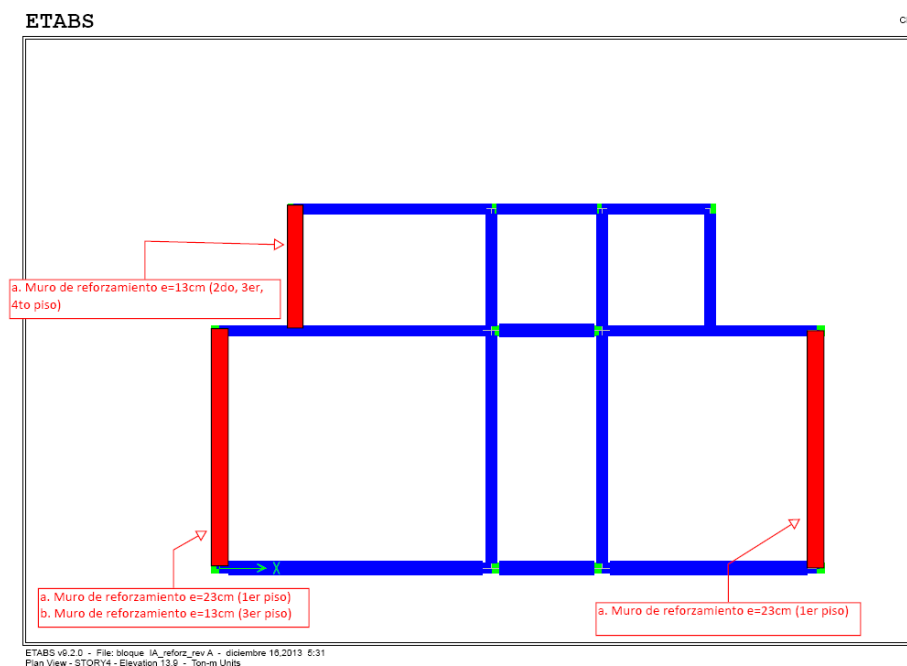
Esquema de reforzamiento con muro de concreto en bloque IA
